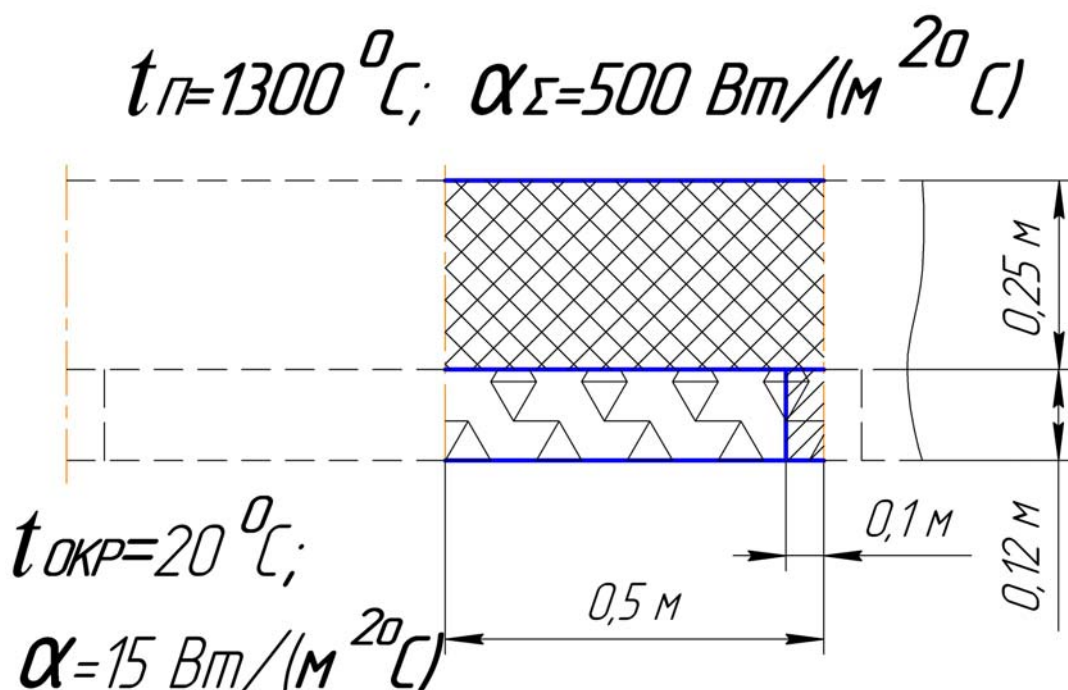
Расчетная схема участка стены (вид сверху)
